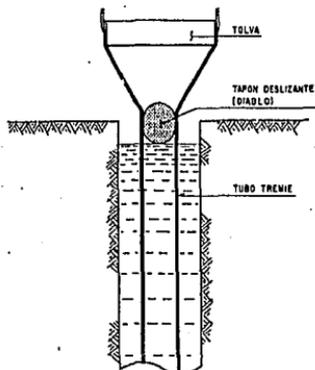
Colocación de tapón deslizante o diablo en la tubería tremie
